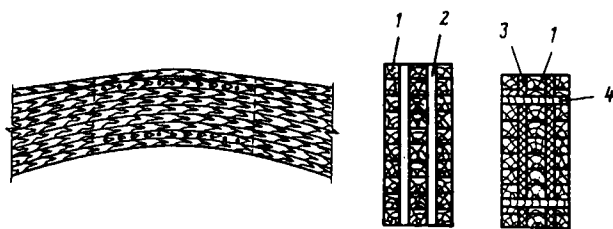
Усиление коньковой части балки способом предварительного обжатия (по патентам Литовской Республики № 2045 и № 2046): 1 - доски пакета; 2 - сквозной паз; 3 - вкладыши; 4 - нагели
